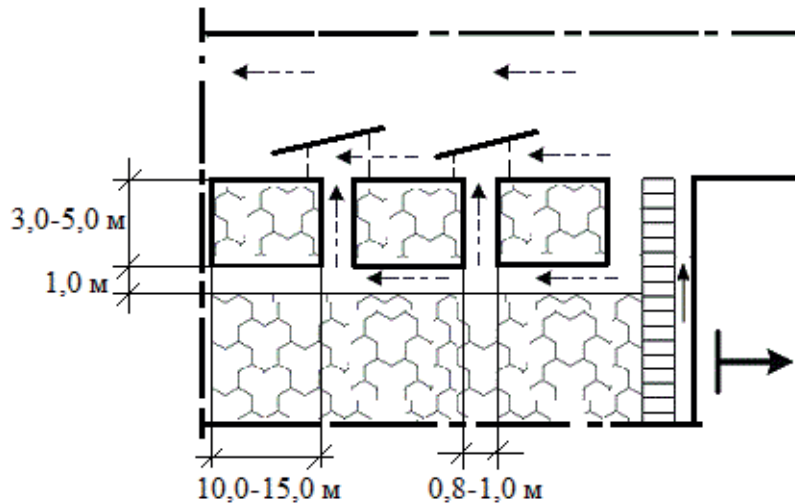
Схема продольных и поперечных каналов в бутовых полосах под вентиляционным штреком с камерами смешивания на штреке
